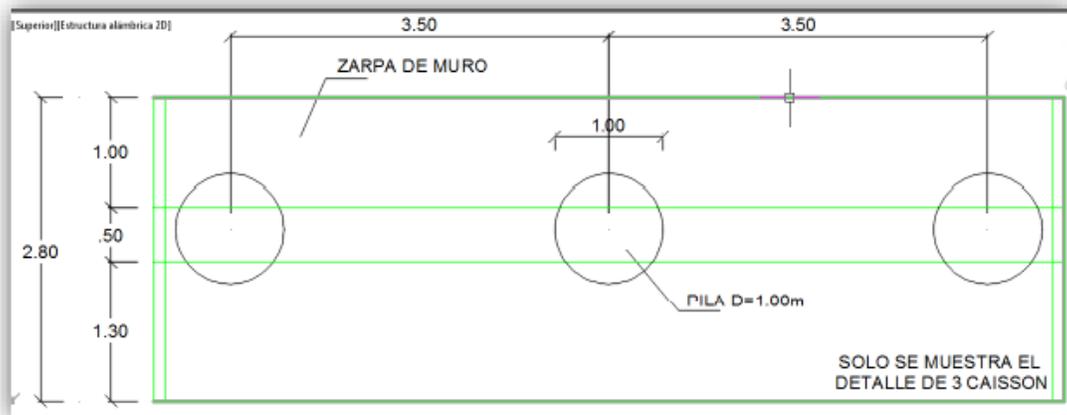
Planta de distribución de pilas en zarpa de muro
